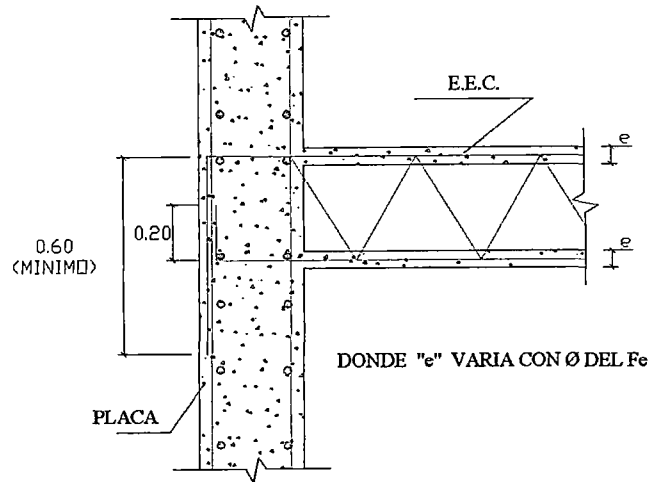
Detalle Típico: Unión de la Placa con la E.E.C. (Estructuración C)
